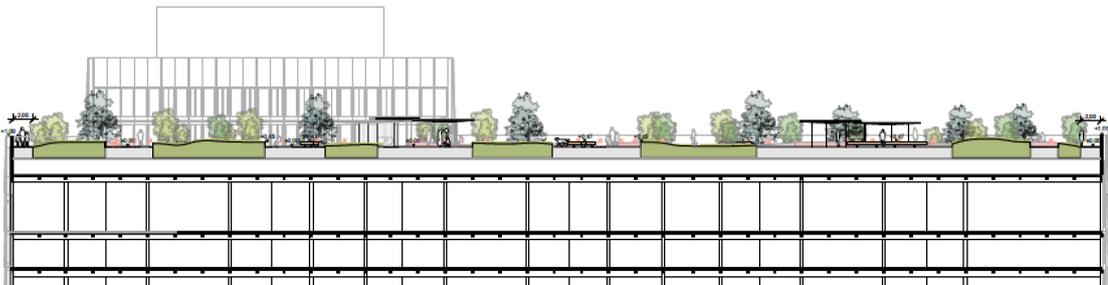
Schnitt durch den Dachgarten mit Blick auf Bauteil B, Quelle: Atelier Loidl
